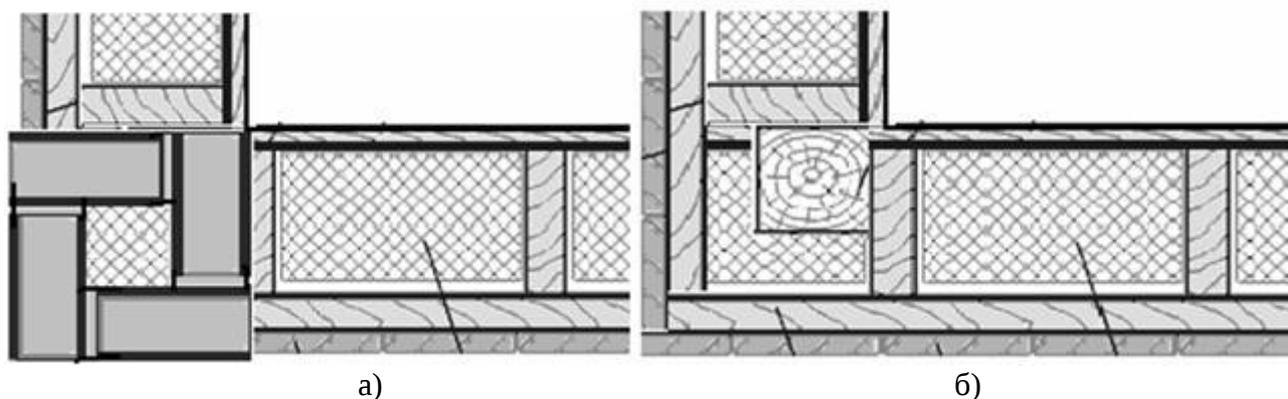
Вид сверху стены с несущими колоннами: а) кирпичными; б) деревянными.
